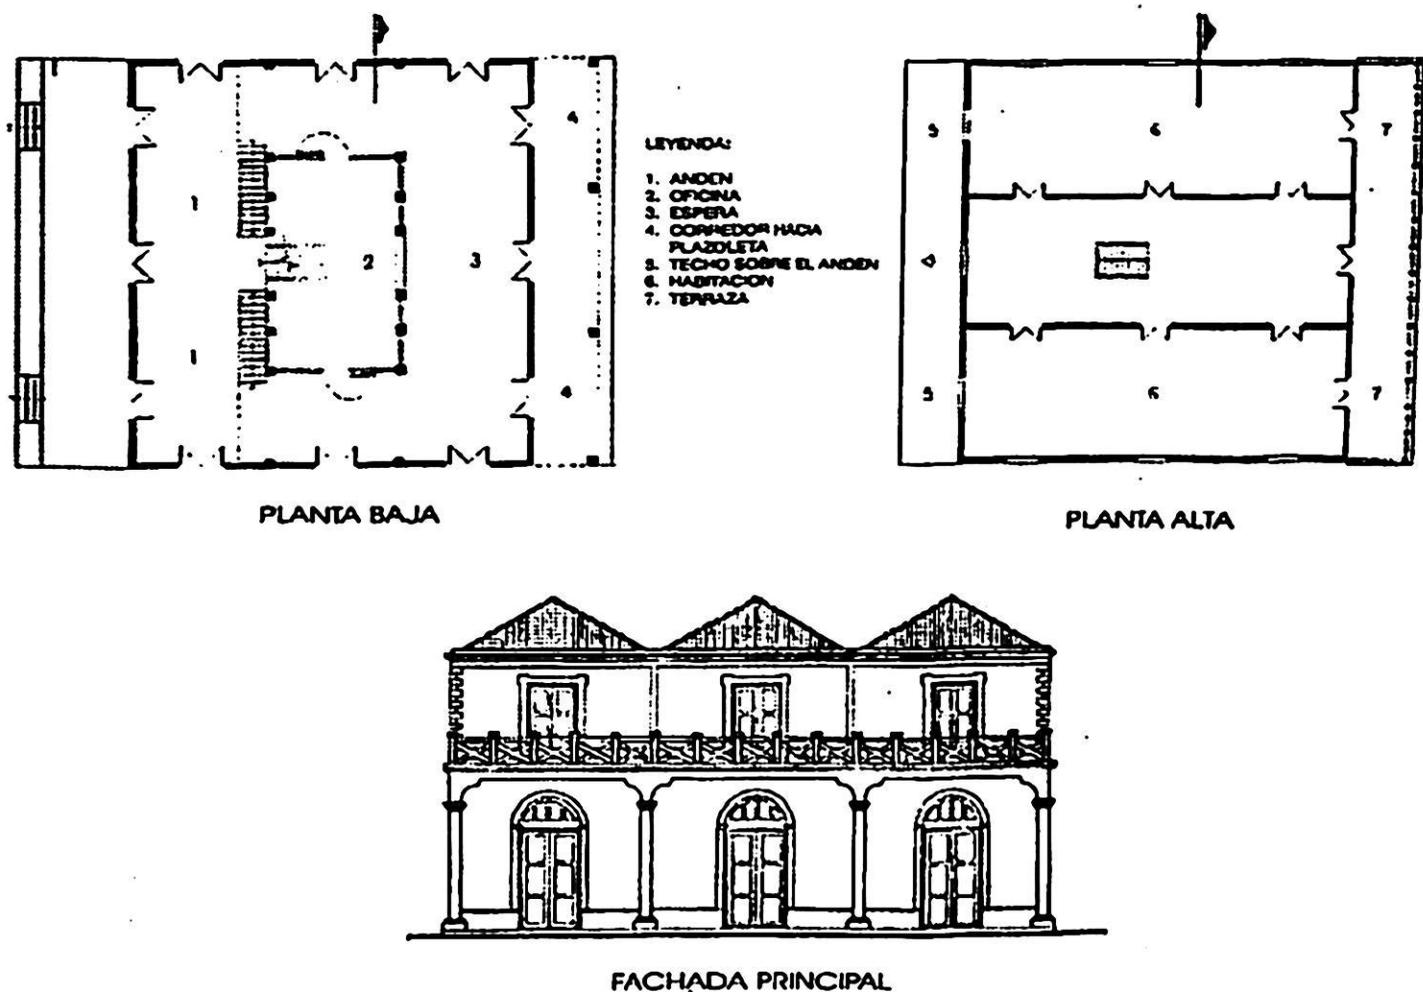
Plantas y fachada del edificio principal de la Estación Táchira. Fuente: ARELLANO CÁRDENAS, Alfonso J. 1996. La arquitectura de la Compañía "Gran Ferrocarril del Táchira", 1893-1926. Caracas. Universidad Central de Venezuela, Facultad de Arquitectura y urbanismo, p. 373.
